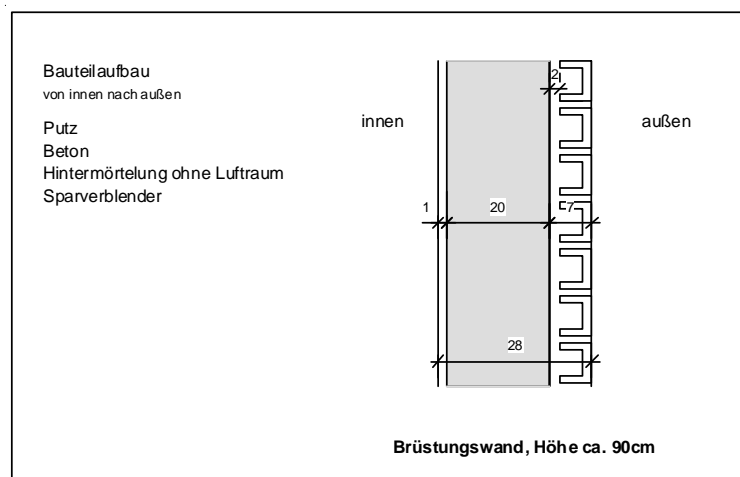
Ermittelter Bauteilaufbau auf Grundlage der Bauteilöffnung
